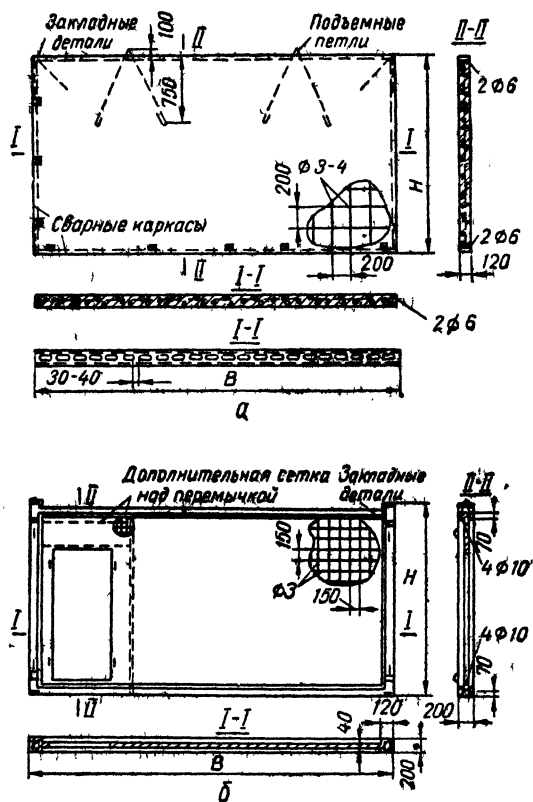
Конструкции панелей несущих внутренних стен;
